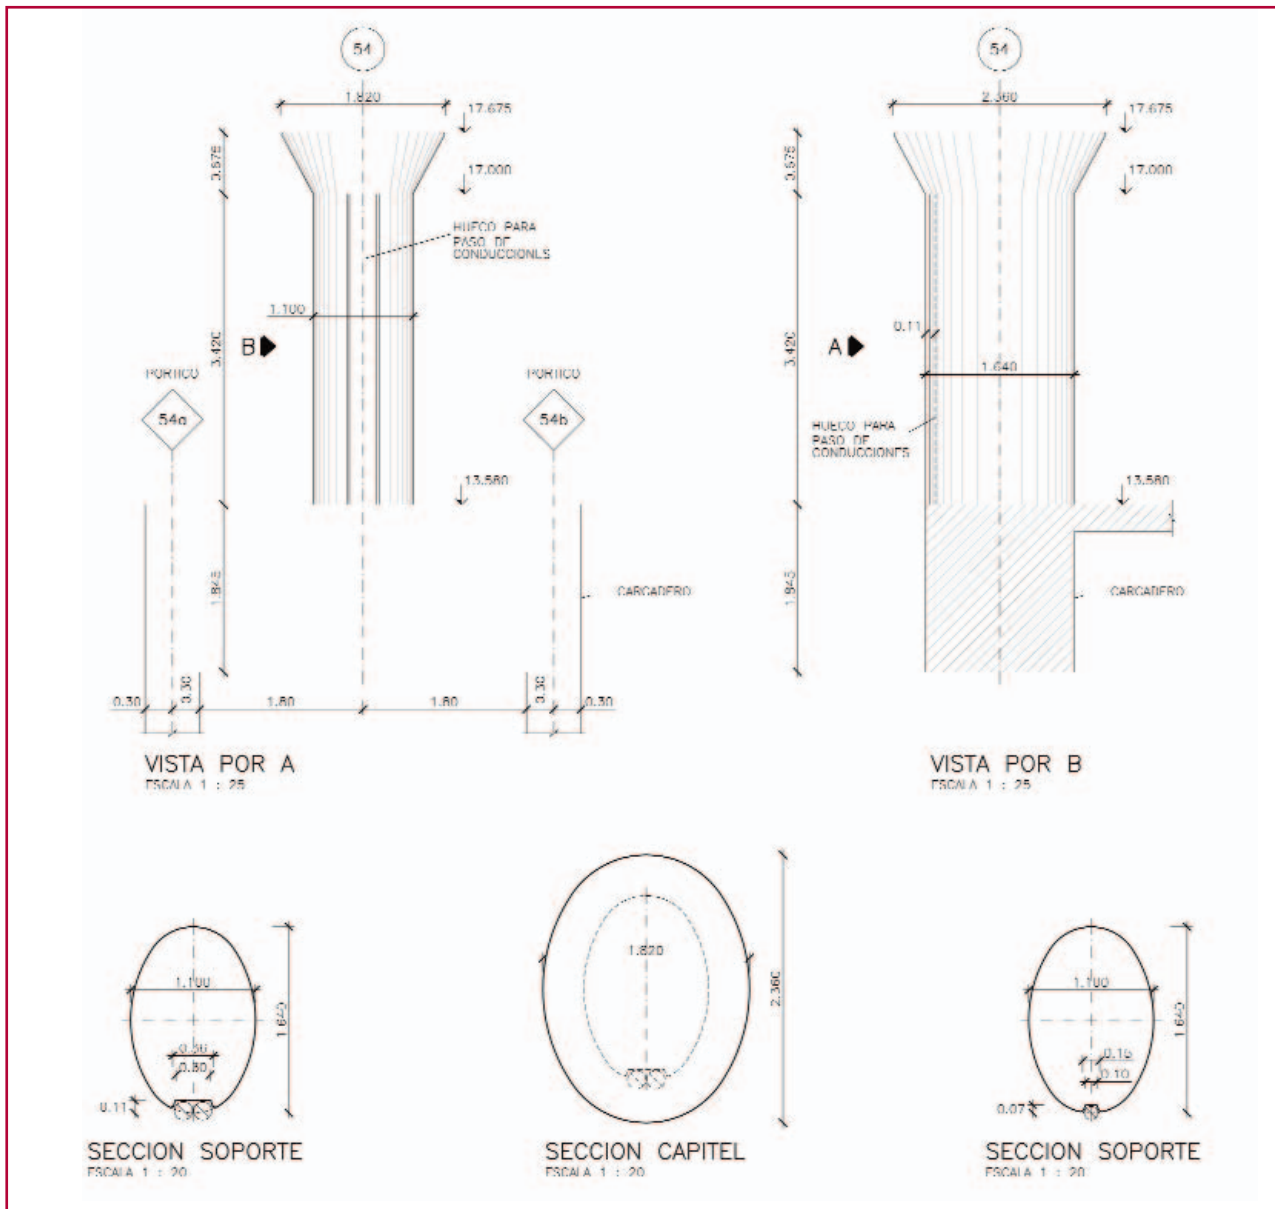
Alzado y secciones del soporte tipo en la zona correspondiente al nuevo graderío.
